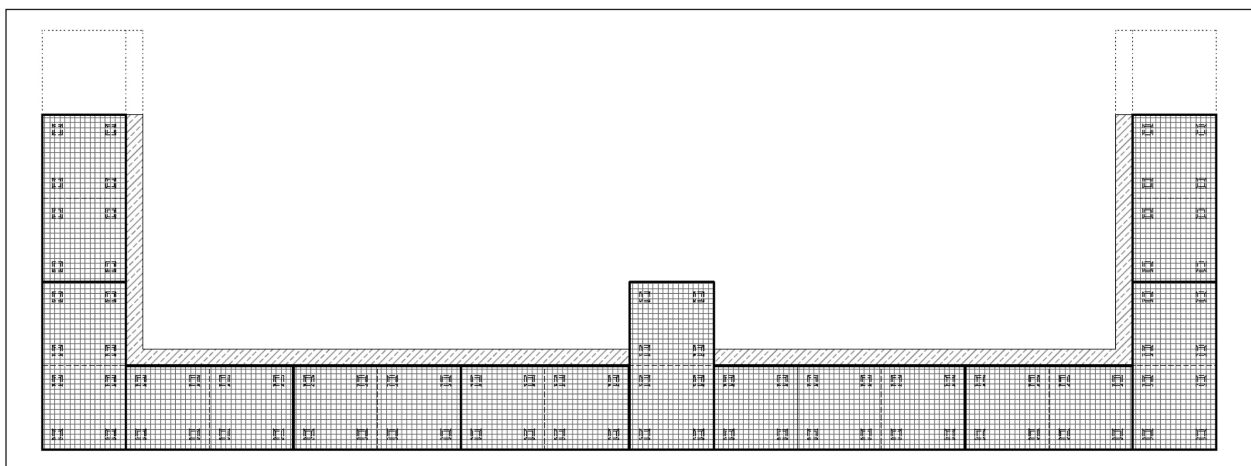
Grundriss Widerlager, Modulbauweise mit Blocksteinen (Breite 3 m)
